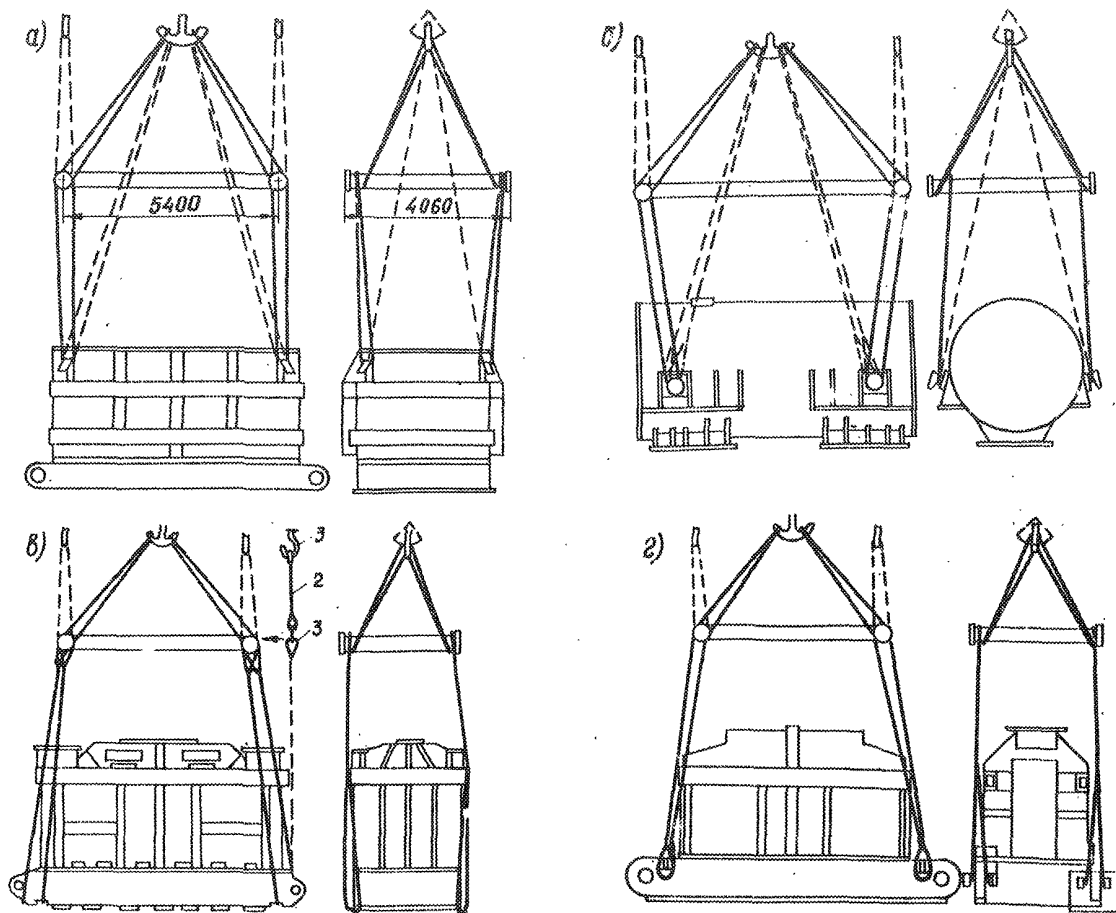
Схемы строповки грузов. Условные обозначения: а - строповка груза за специальные гаки; б - строповка груза за рым-лапы; в - строповка груза под несущую балку; г - строповка груза за специальные места, расположенные на несущей балке
